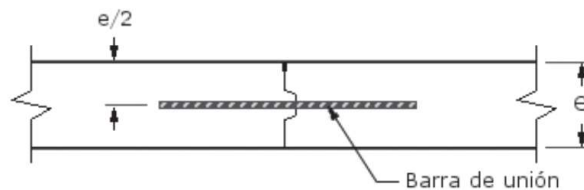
JUNTA TIPO D-1. JUNTA LONGITUDINAL DE CONSTRUCCIÓN CON BARRAS DE UNIÓN.
